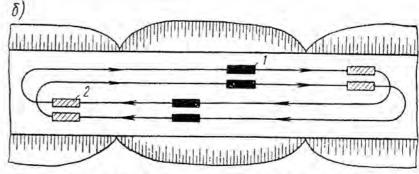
Схема движения скрепера при разработке грунта в выемке с перемещением его в насыпь.
